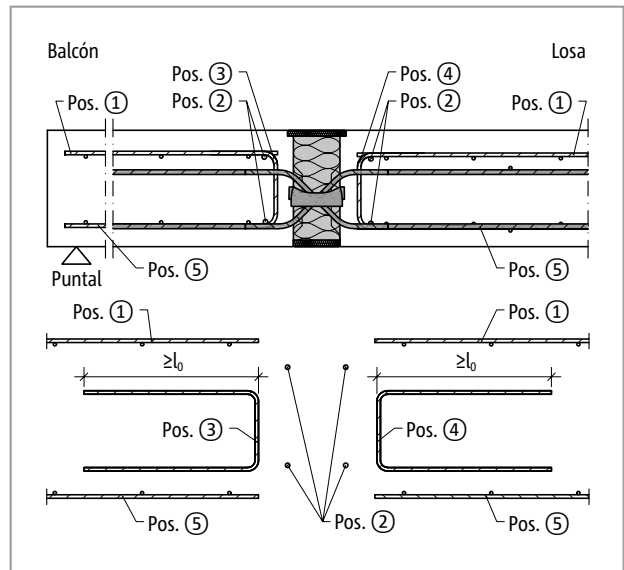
Schöck Isokorb® T tipo Q-VV6 hasta Q-VV10: Armadura in situ
